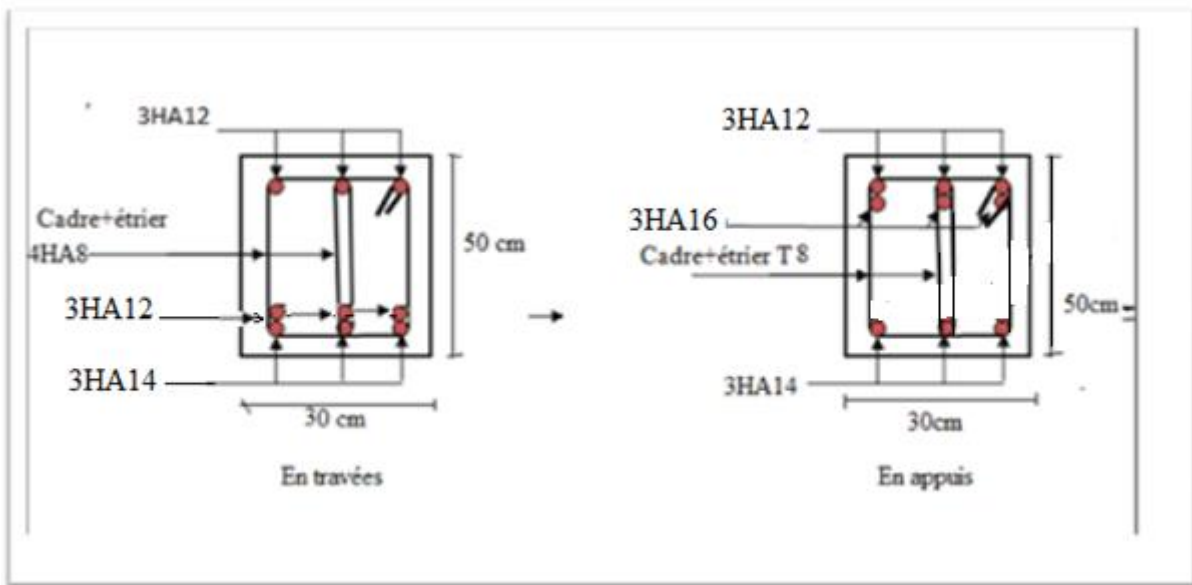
schéma de ferrailage poutres principales étage 1 aux 8^{ème}
